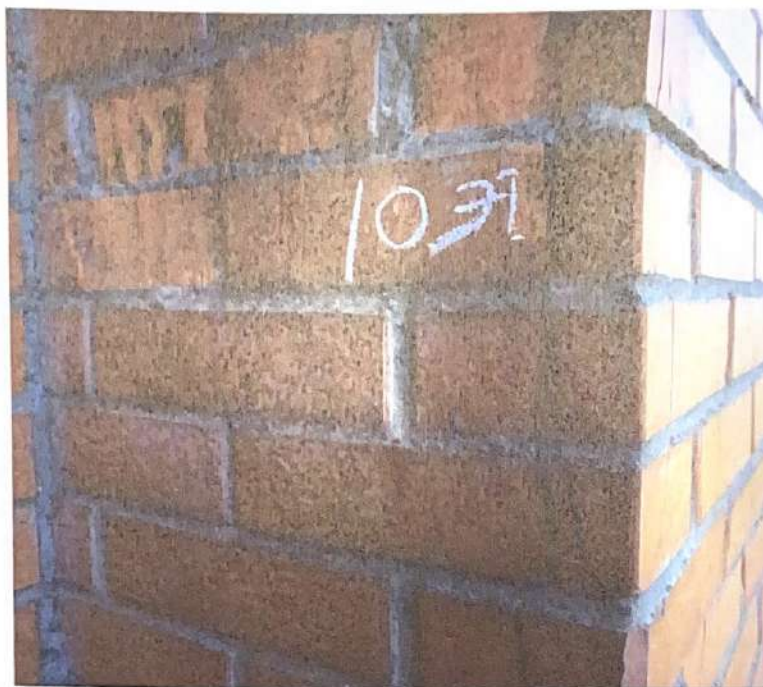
Секция 11. Фасад 2. Разрушение кирпича. Вертикальная трещина по наружной версте.
